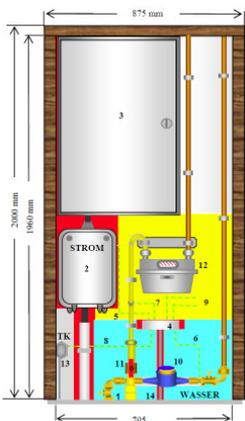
Ausführungsbeispiel einer Hausanschlusswand
